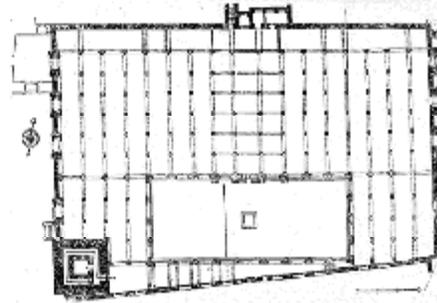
مسقط أفقي للجامع الموحدي بتازة
